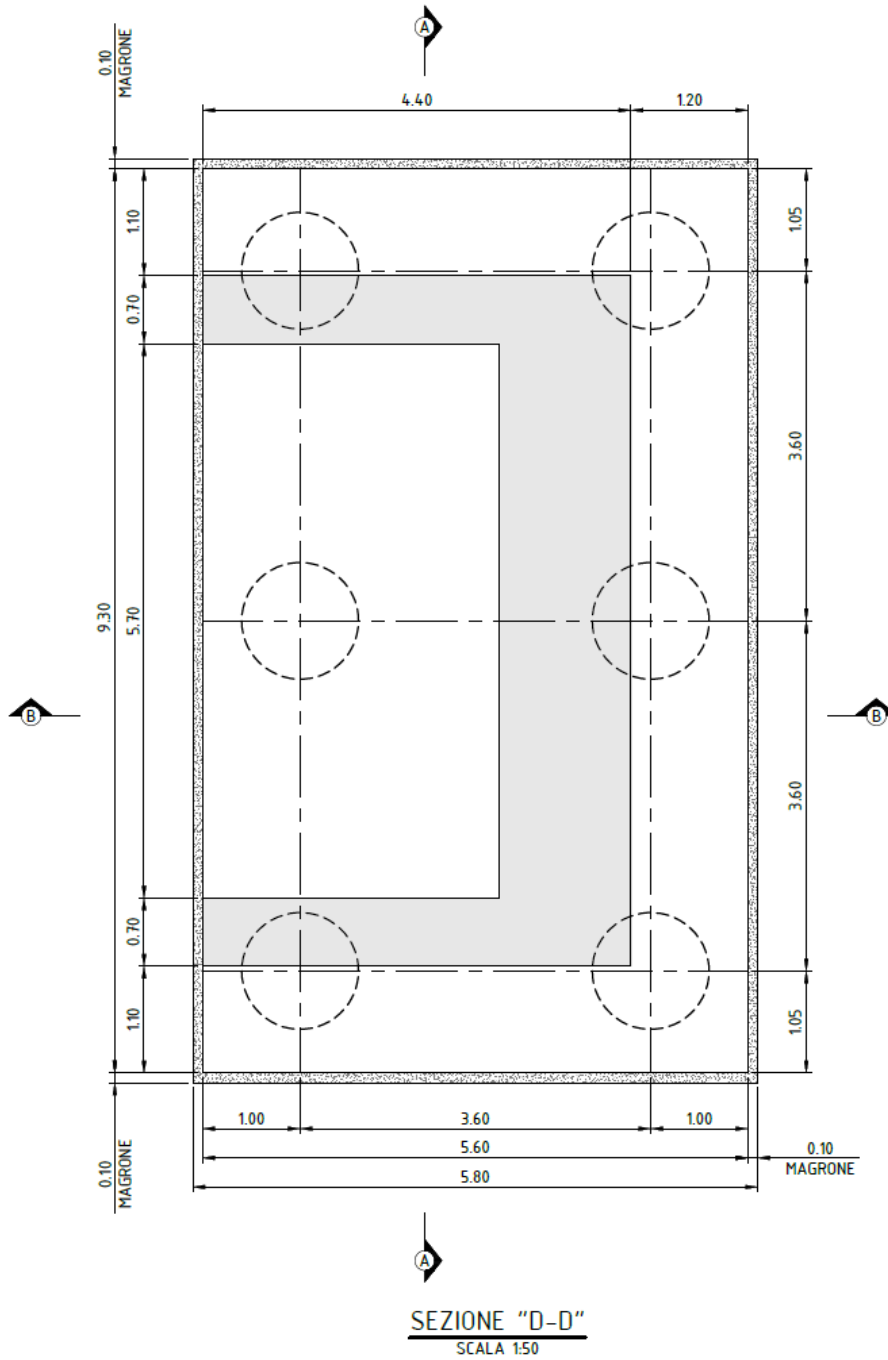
Vista in pianta della spalla (estradosso della platea di fondazione)
